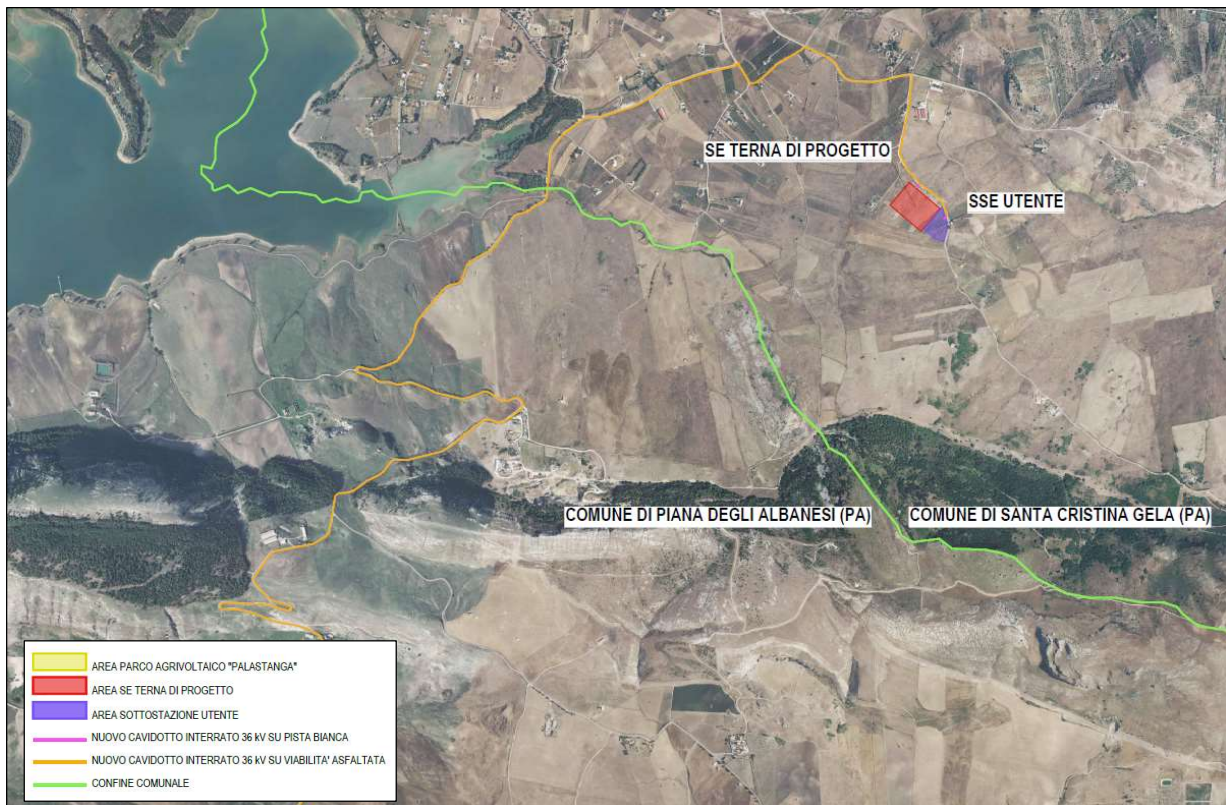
Inquadramento opere in progetto (area stazioni) su Ortofoto (Scala 1:10000)
